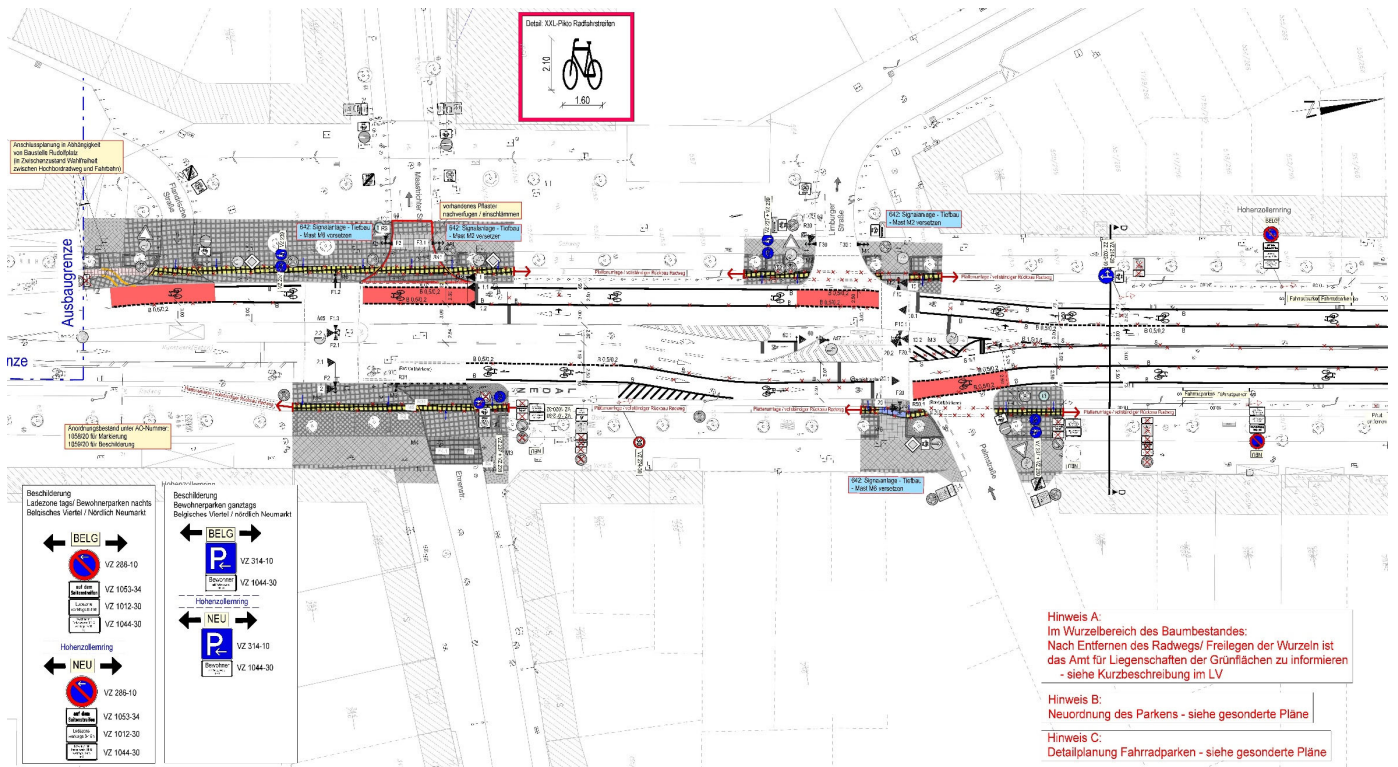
| Typischer Umgestaltungsansatz im Lageplan: Ummarkierung der äußeren Fahrstreifen zu 2,50 m breiten Radfahrstreifen, Umwandlung vorhandener Längsparkstreifen in Ladezonen (8-19 Uhr) bzw. Bewohnerparkzonen (19-8 Uhr), Anpassung der Lichtsignalanlagen – hier: Planung zum Hohenzollernring
